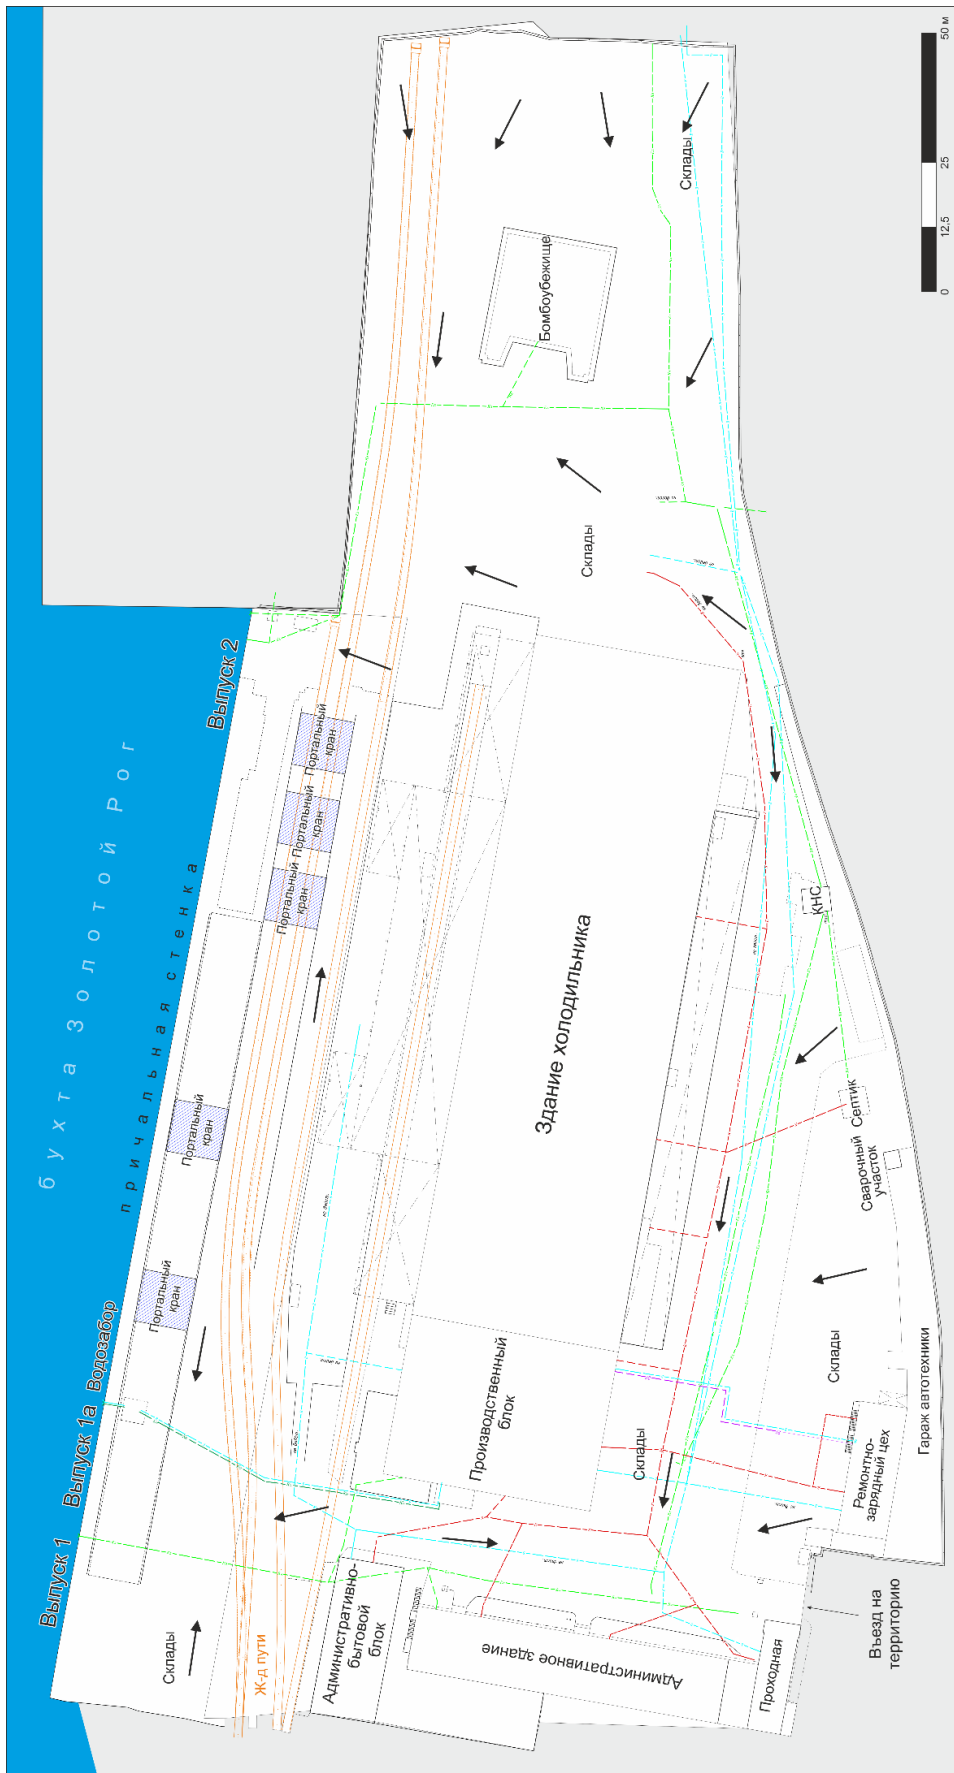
Покрытие площадки и инженерные сети площадки Причал 44
